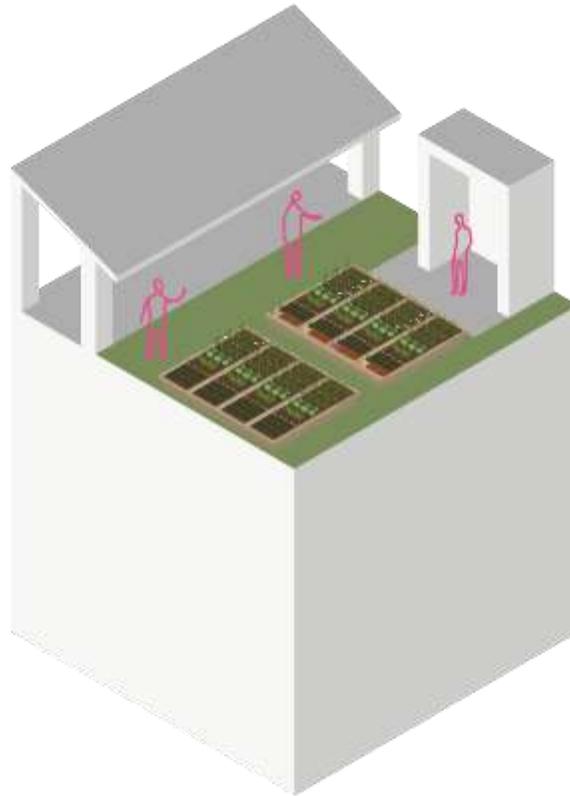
Cubierta verde con huerta de autoconsumo y planos inclinados para la captación de recursos naturales
